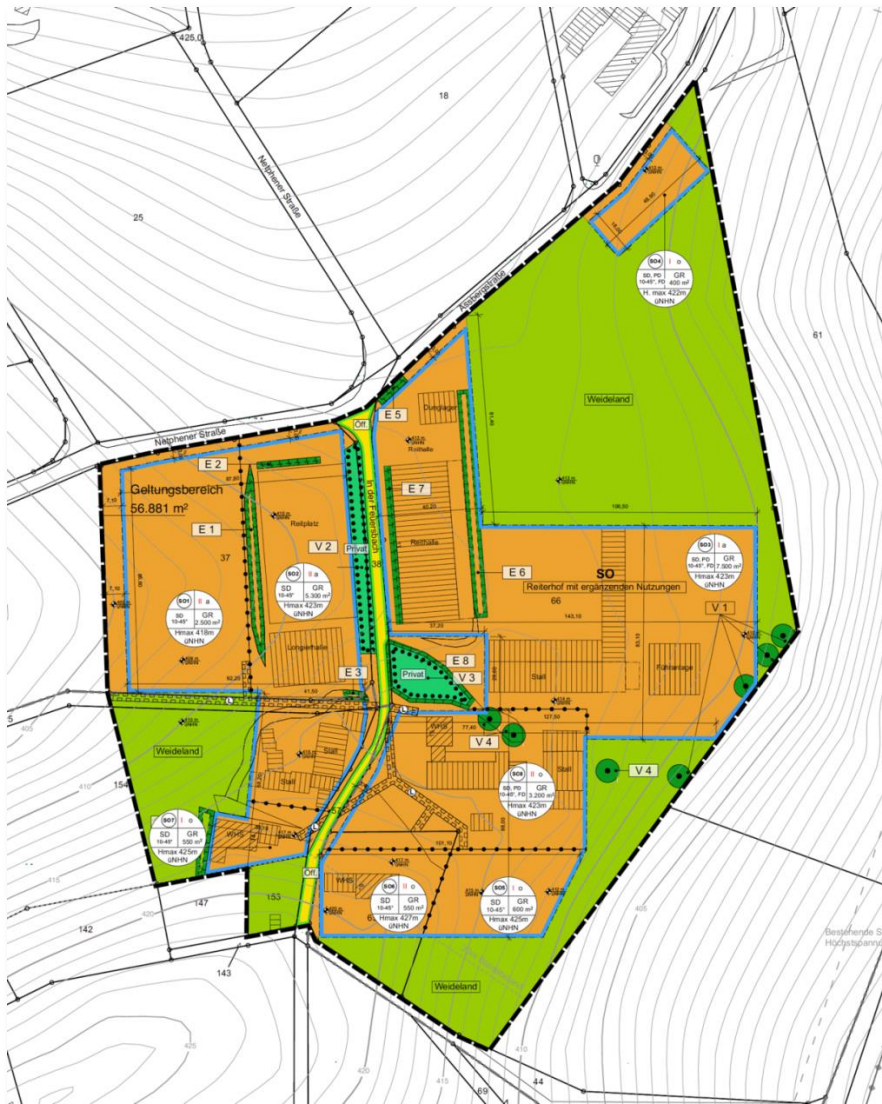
Bebauungsplan Entwurf in der Fassung vom 07.02.2022
